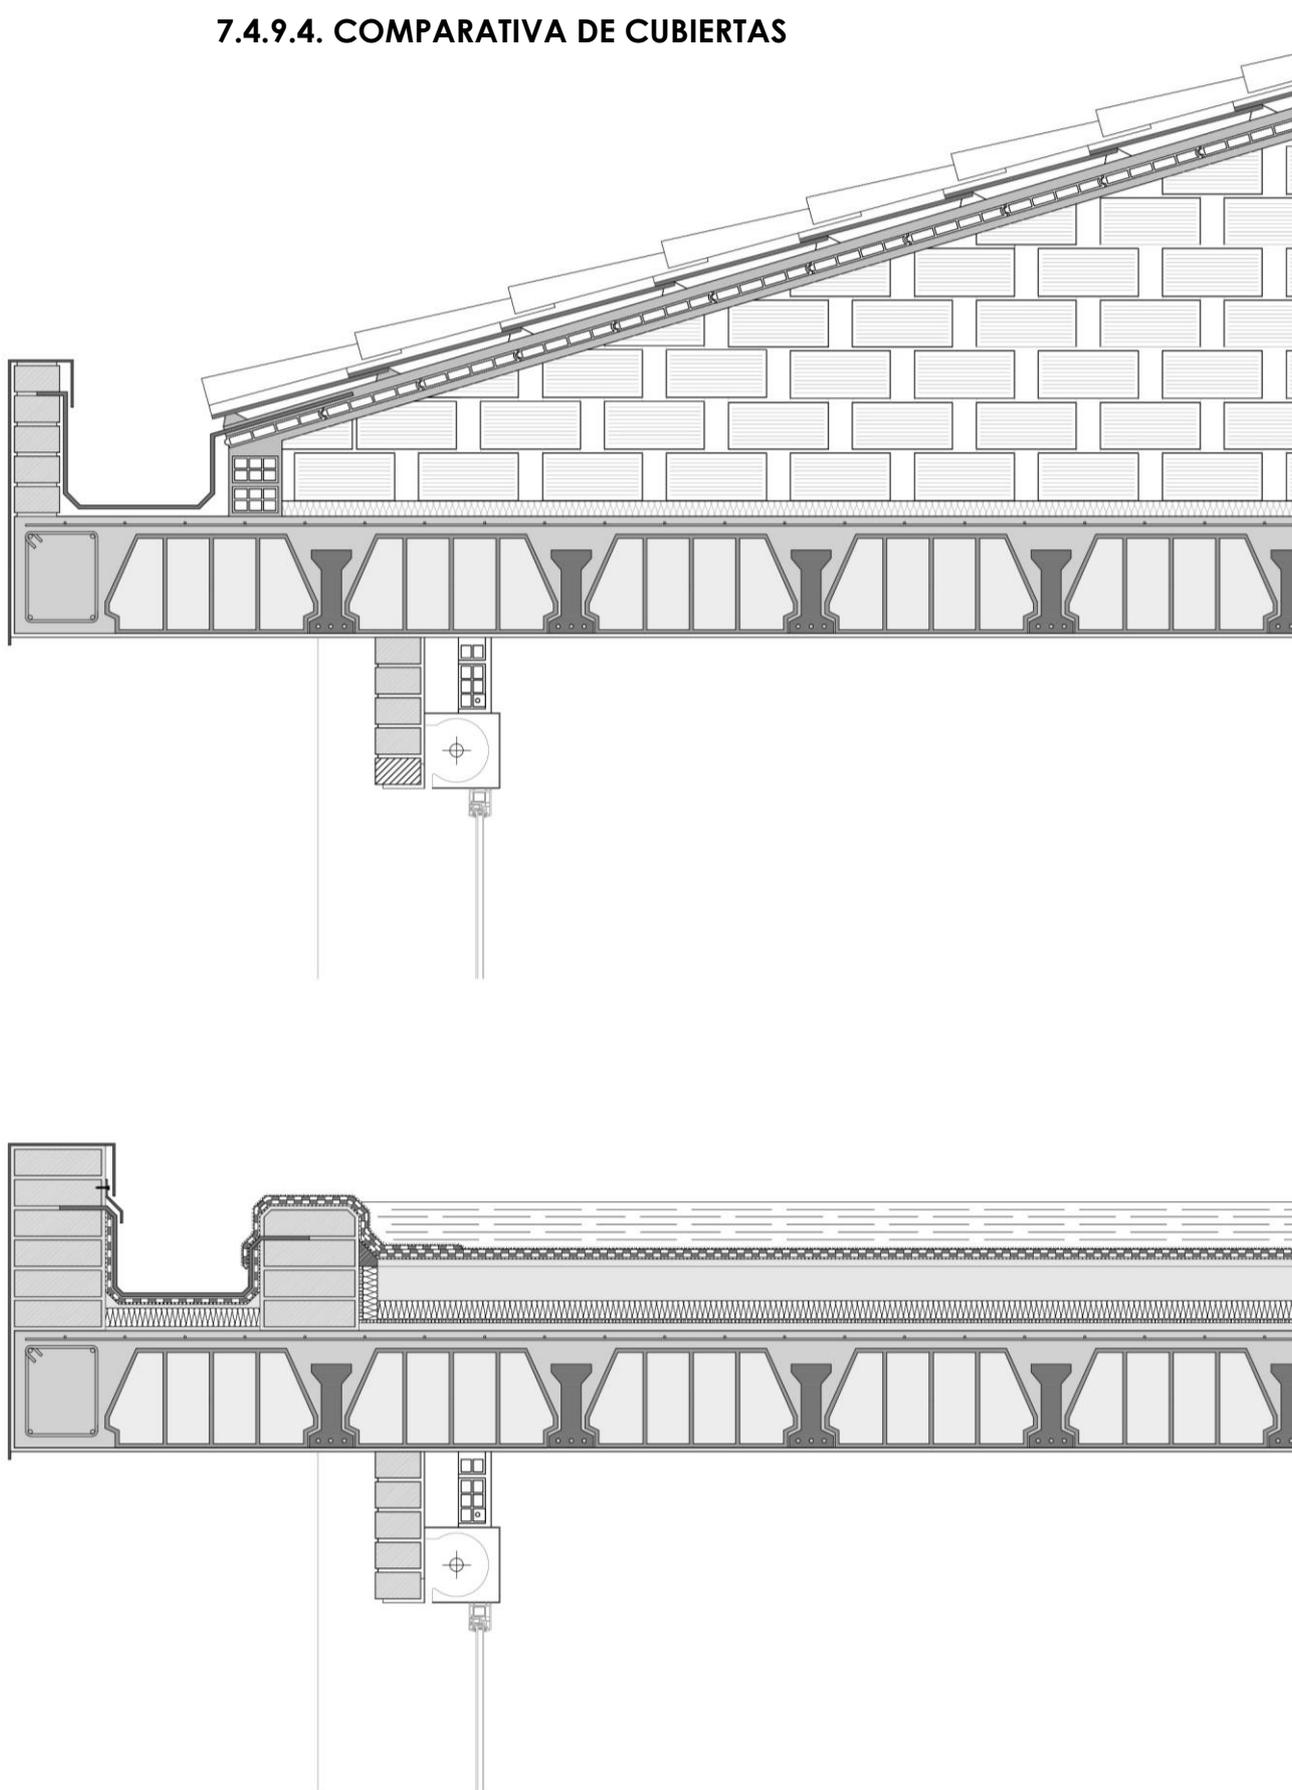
Secciones tipo del colegio. Cubierta inclinada (arriba) y cubierta plana inundada tipo convencional (abajo). E: 1/20
